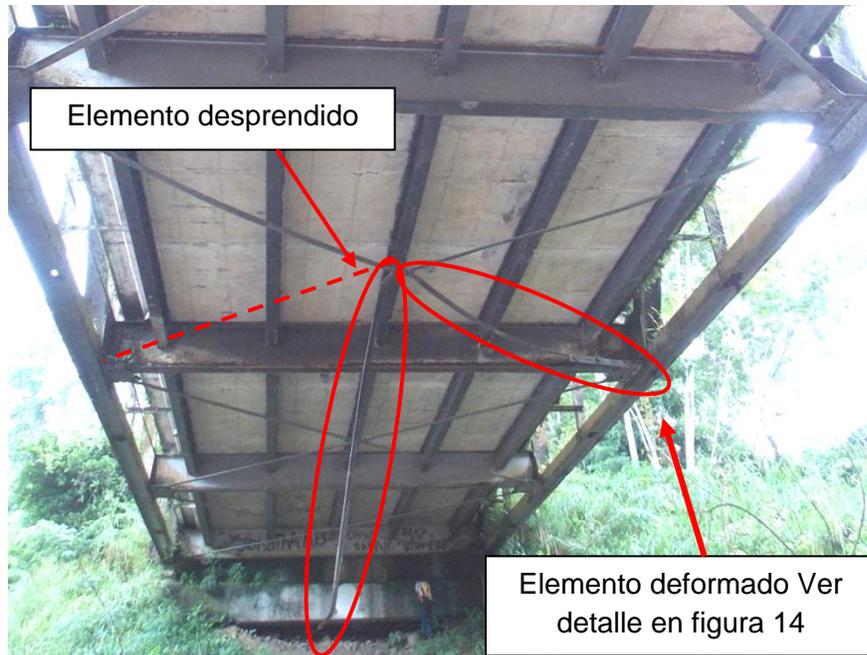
Conexiones expuestas a la lluvia, elemento desprendido y elemento deformado en el sistema de arriostamiento inferior del puente.
